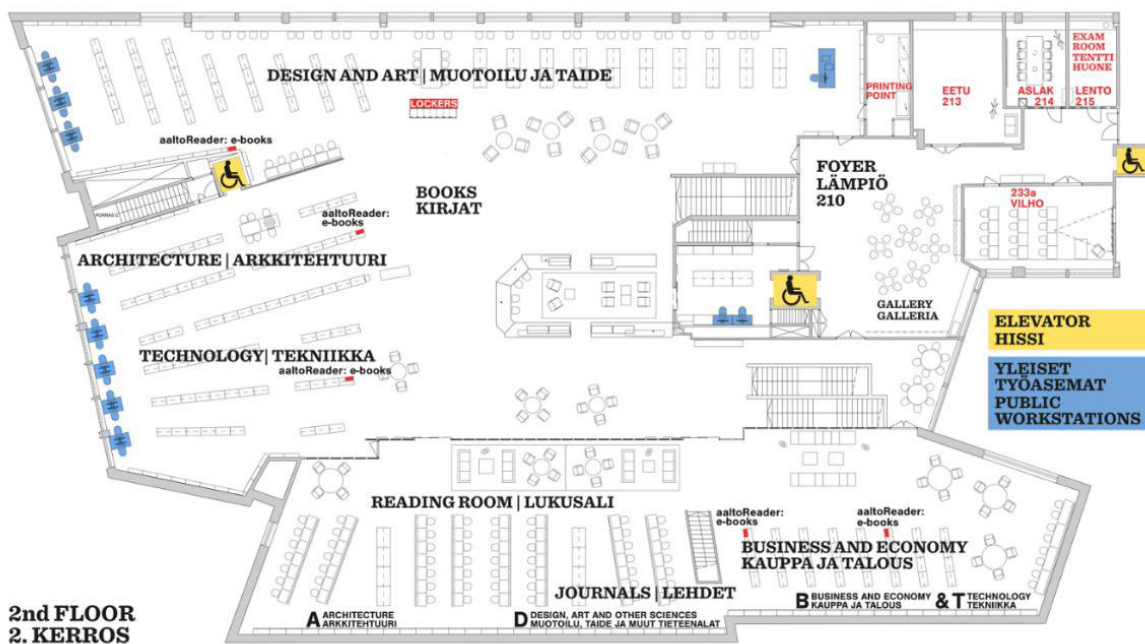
HHLC Grundriss 1. Obergeschoss (2. Floor). Quelle: http://web.lib.aalto.fi/c/web/img/lc_img/2KRS_web_iso.png (11.06.2020)
